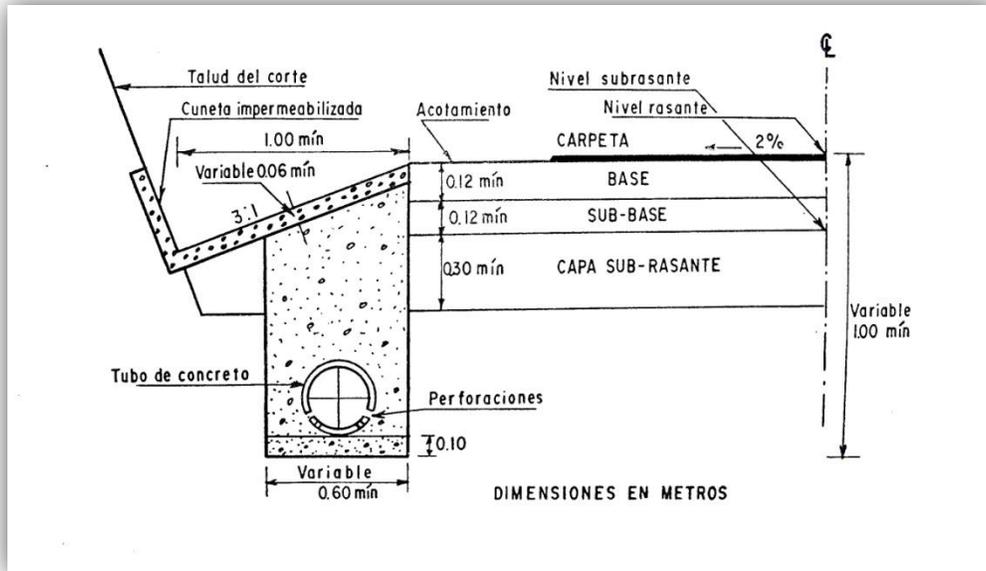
Detalle de la sección transversal de un subdrén longitudinal de zanja, de acuerdo con la práctica mexicana (ref. 18).
